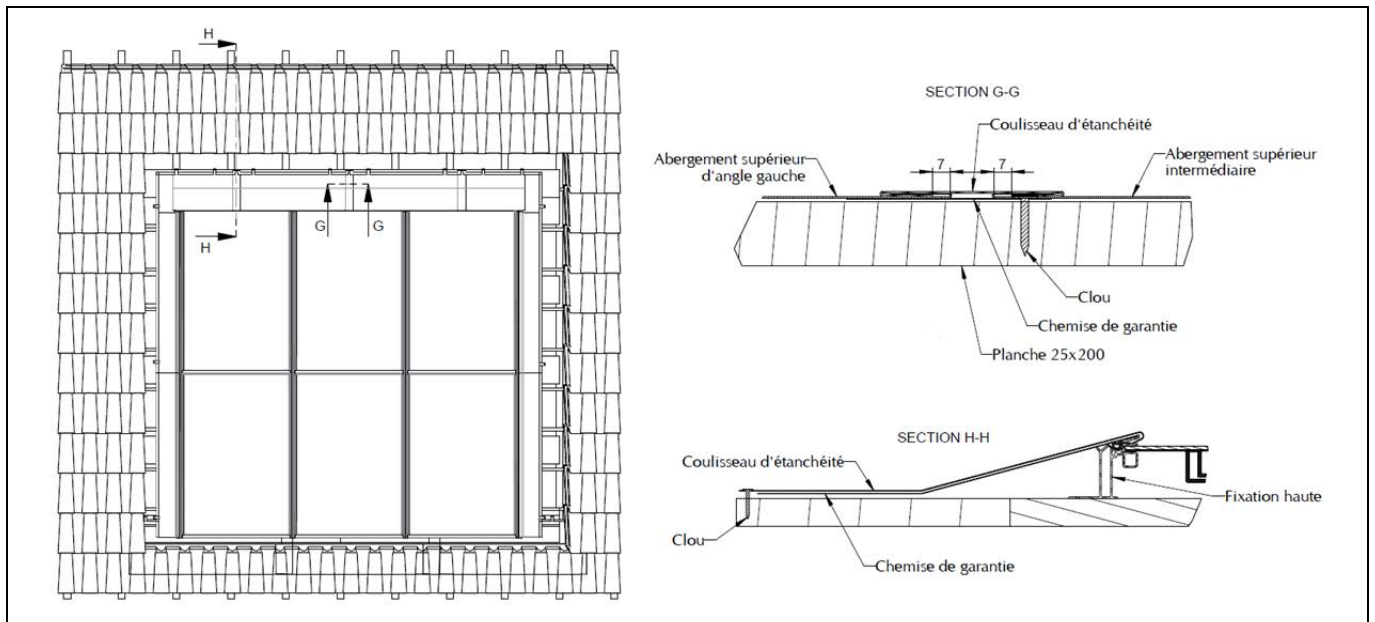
Pose des coulisseaux pour installation sur toiture tuile
